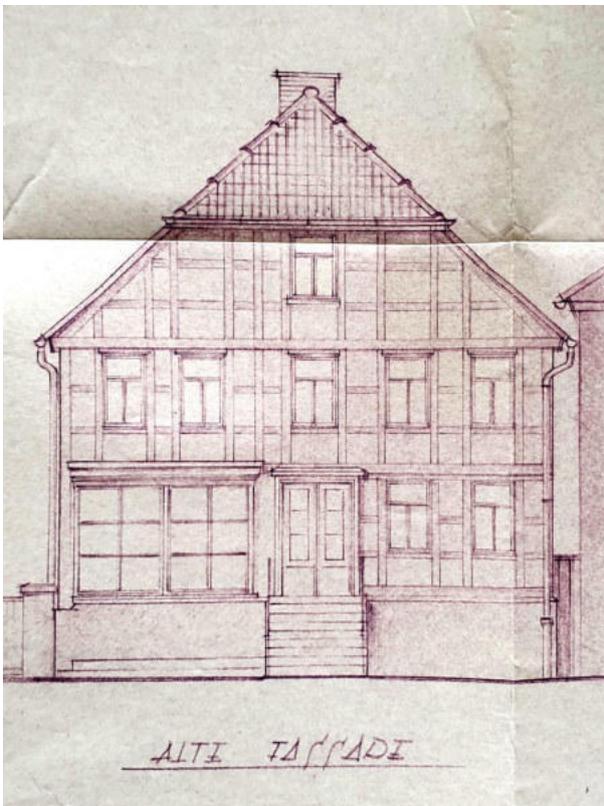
Wie vor, Fassadenansicht vor dem Umbau. In der linken Fassadenhälfte ist bereits ein Schaufenster angelegt.
